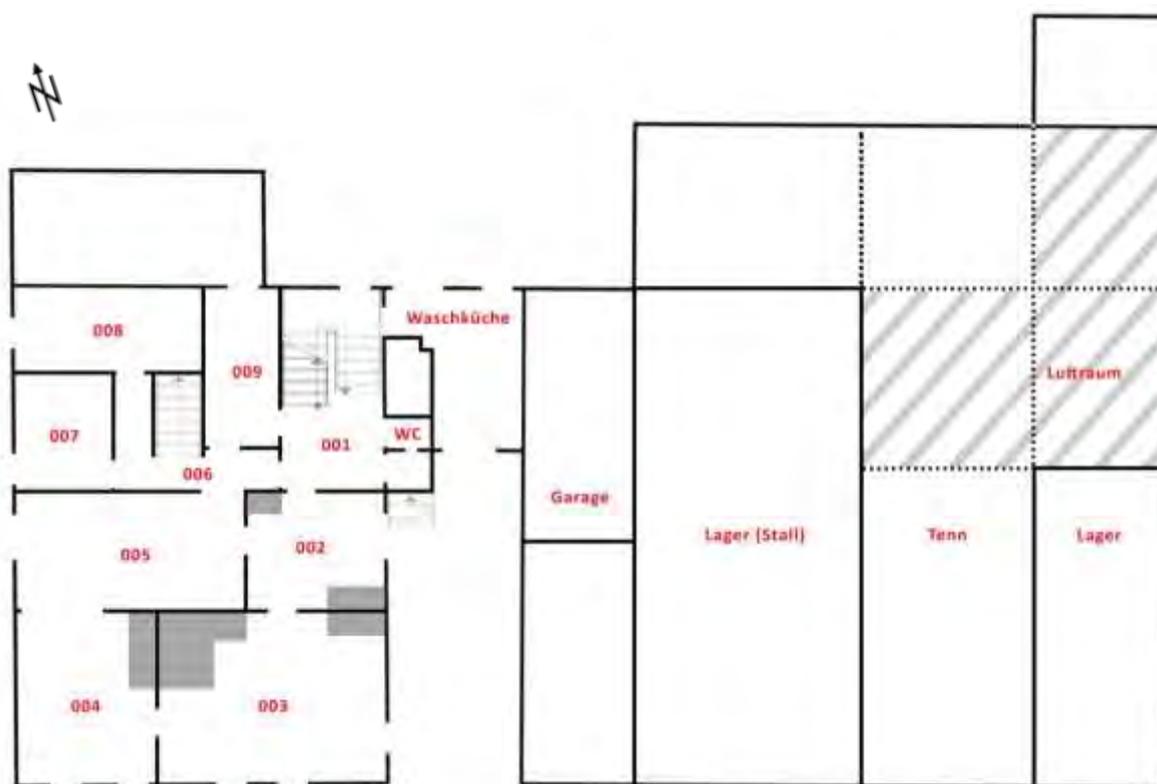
Schematischer Grundriss Erdgeschoss. Bearbeitung IBID.
